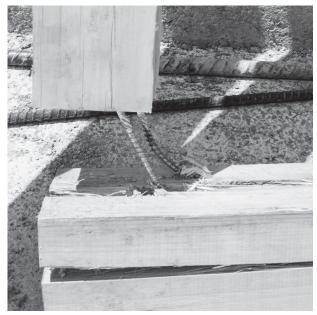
DETALLE DE FALLA EN UNIÓN C DE PRISMA T1, FUENTE: AUTOR
